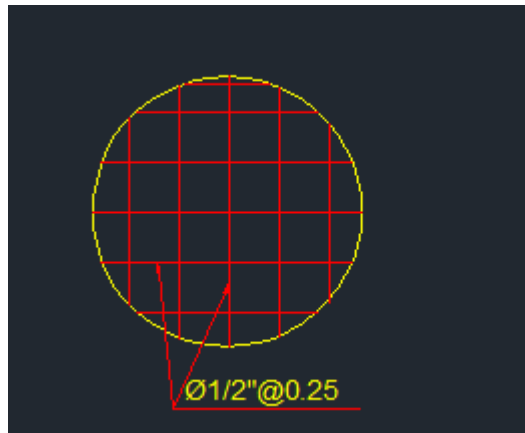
Detalle de barras corrugadas forma de malla de 1/2”
